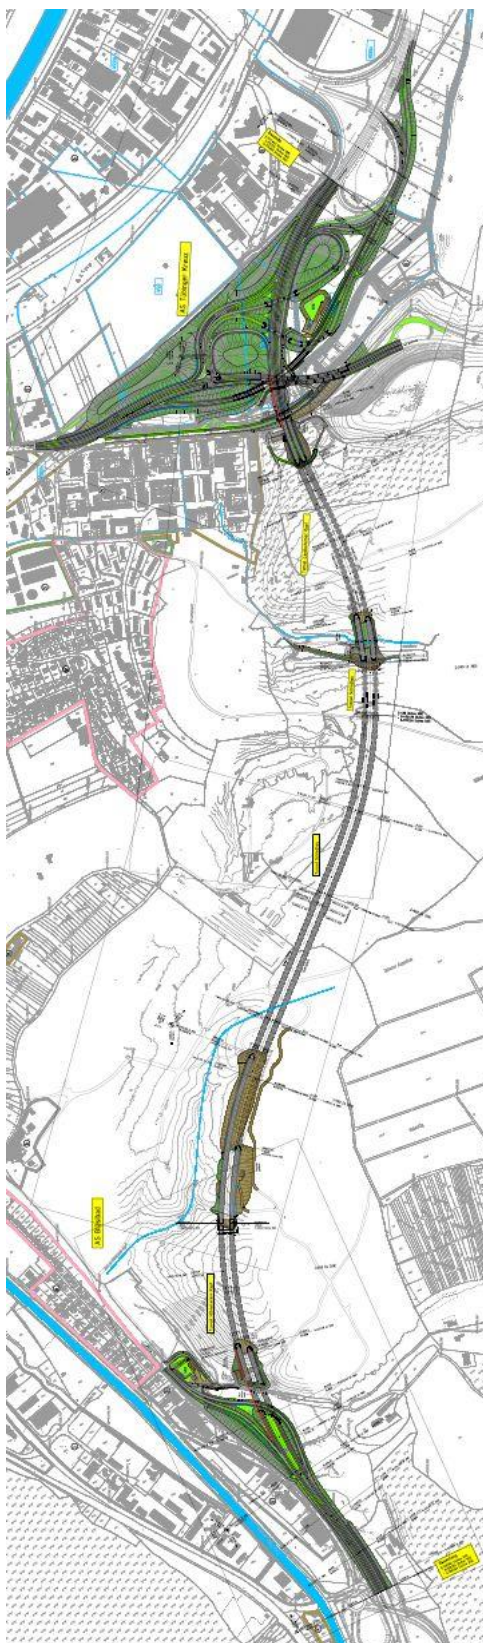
Lageplan der Planvariante A 4 (Quelle: RPT, 2024).
